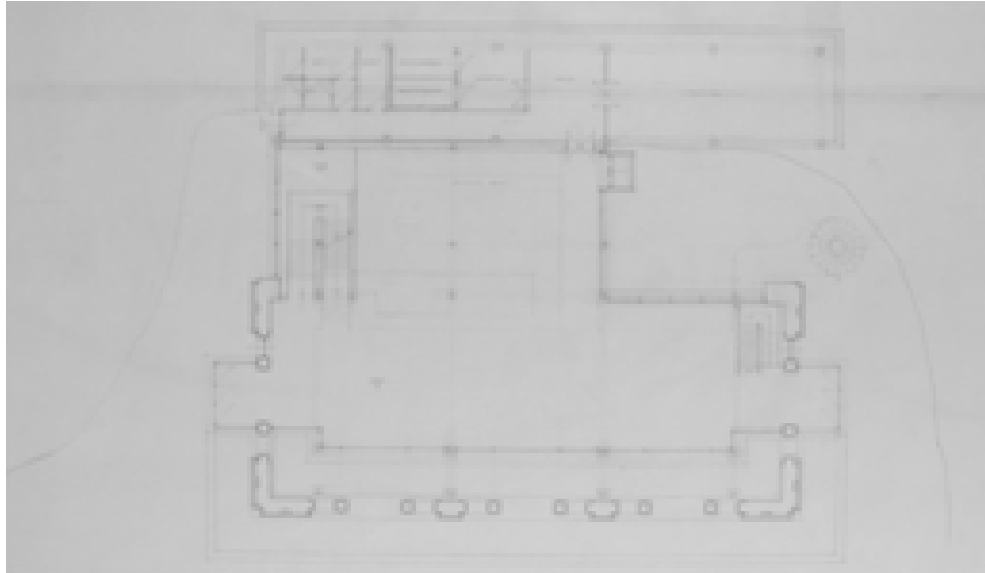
Studio della disposizione planimetrica interna (AABS-978)
